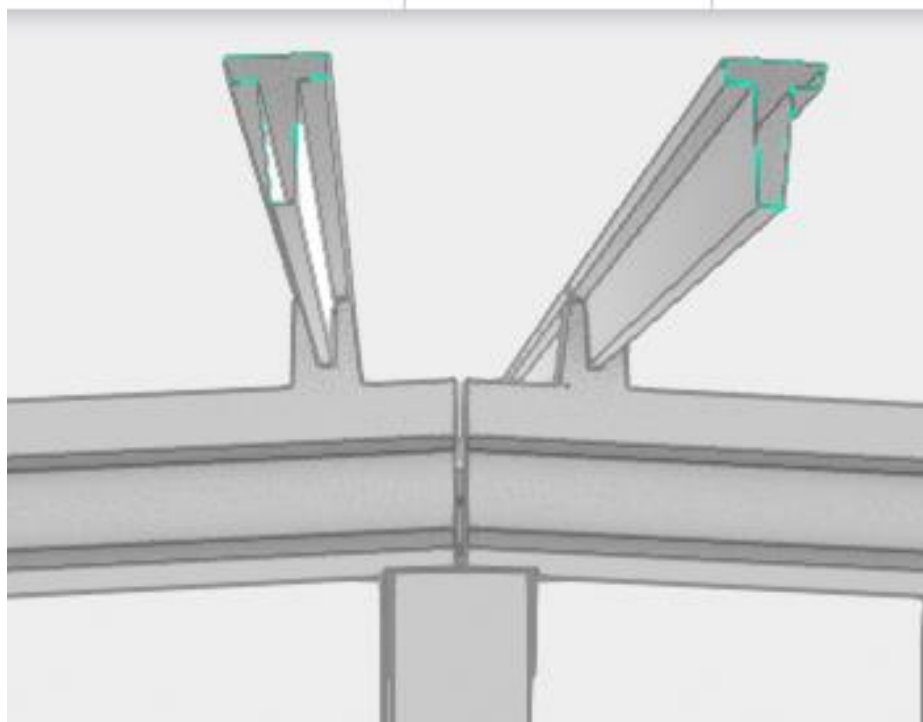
Viga pré-fabricada de concreto com calço para apoio de terça
